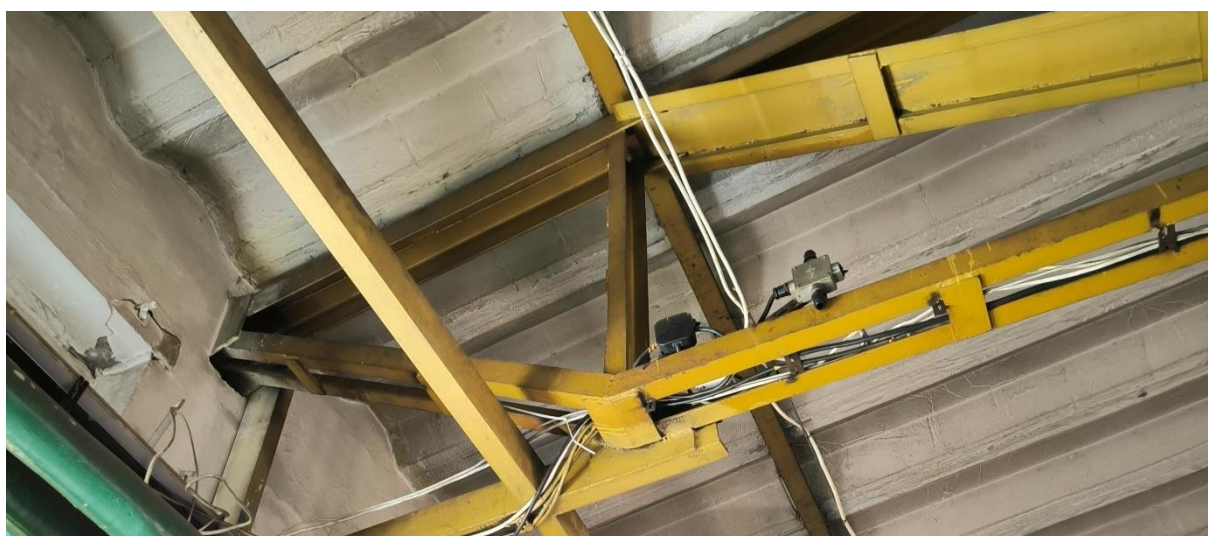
Geometria ustroju nośnego konstrukcji dachu
